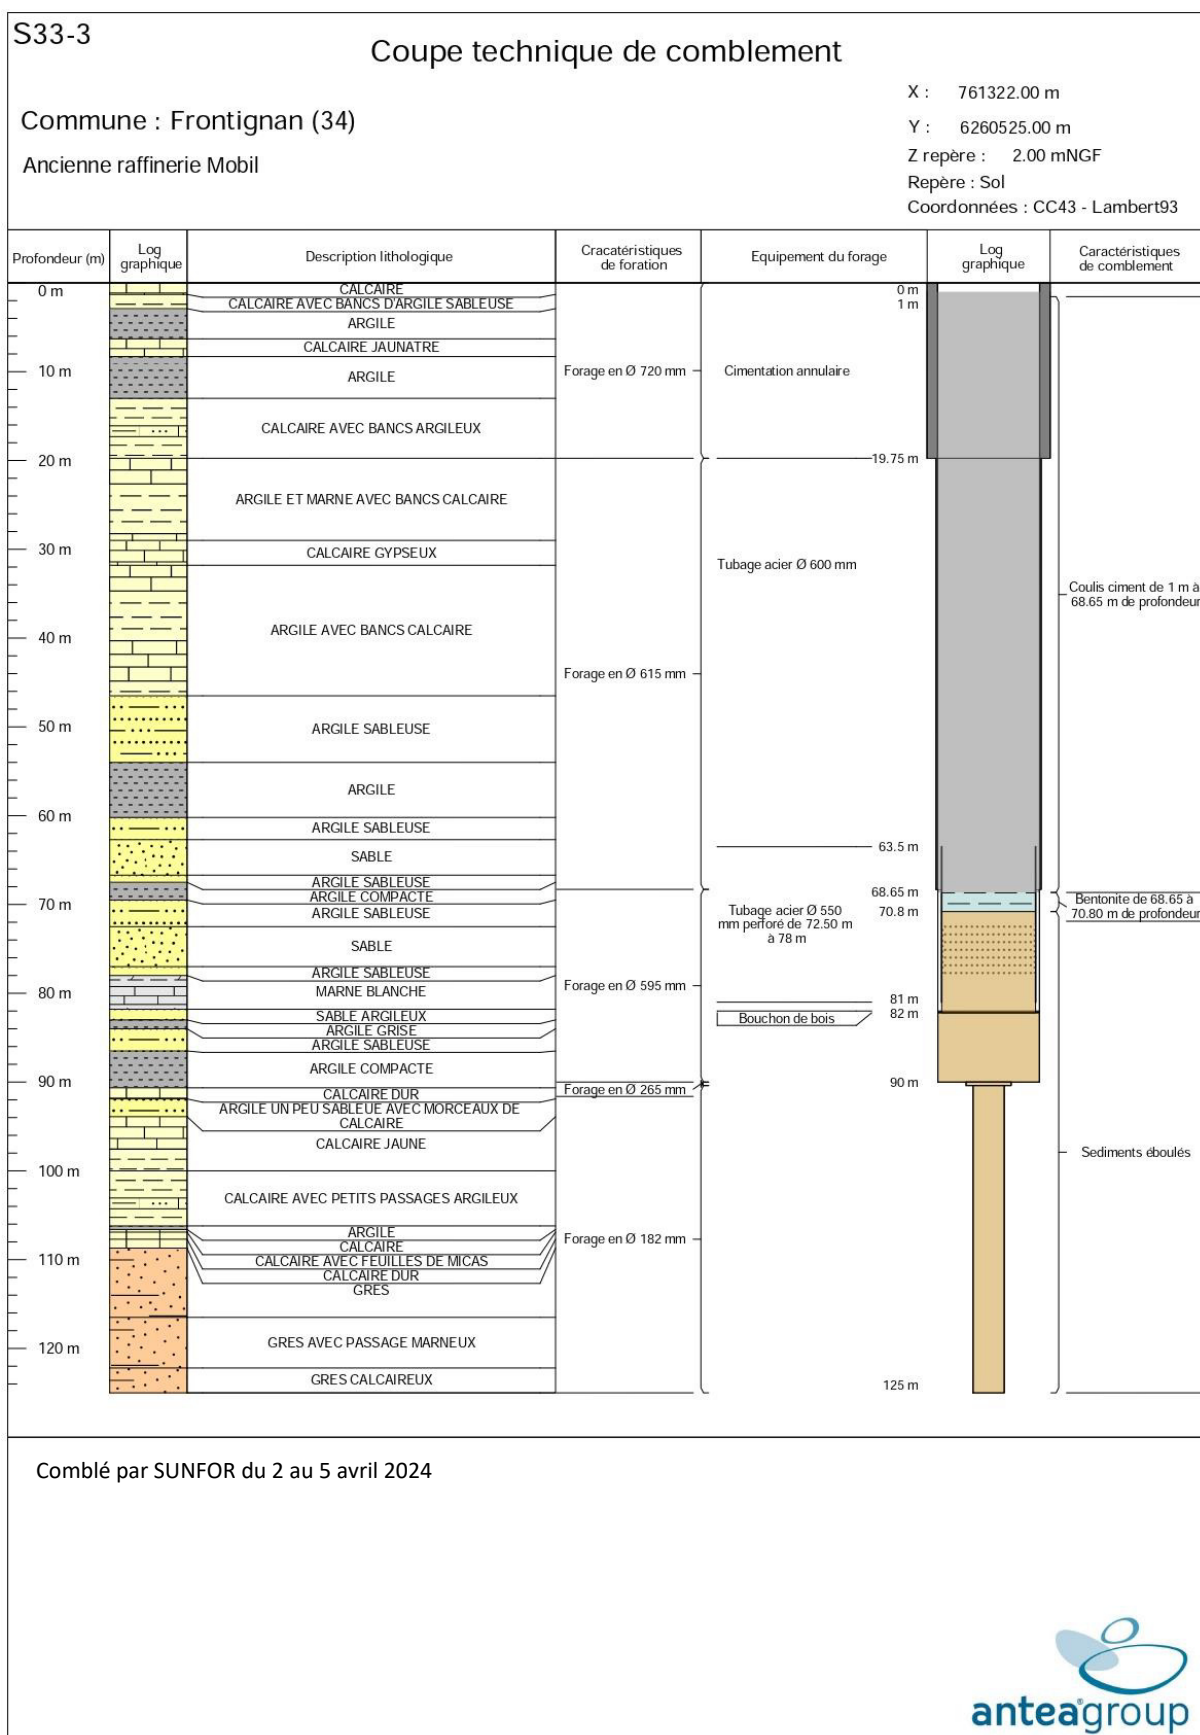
Coupe technique de comblement de l'ouvrage S33-3
